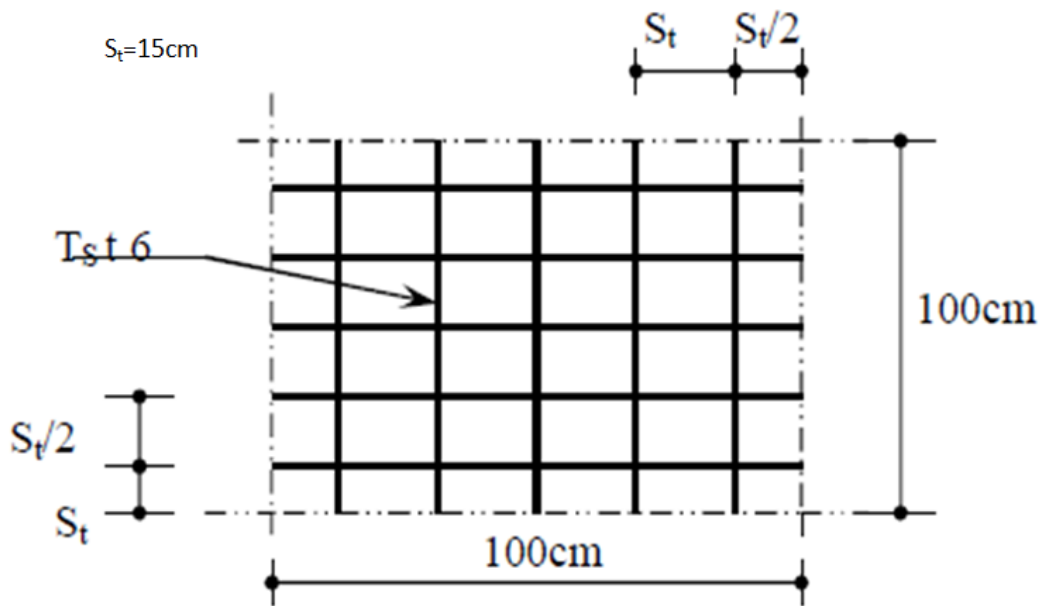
Disposition constructive des armatures de la dalle de compression
